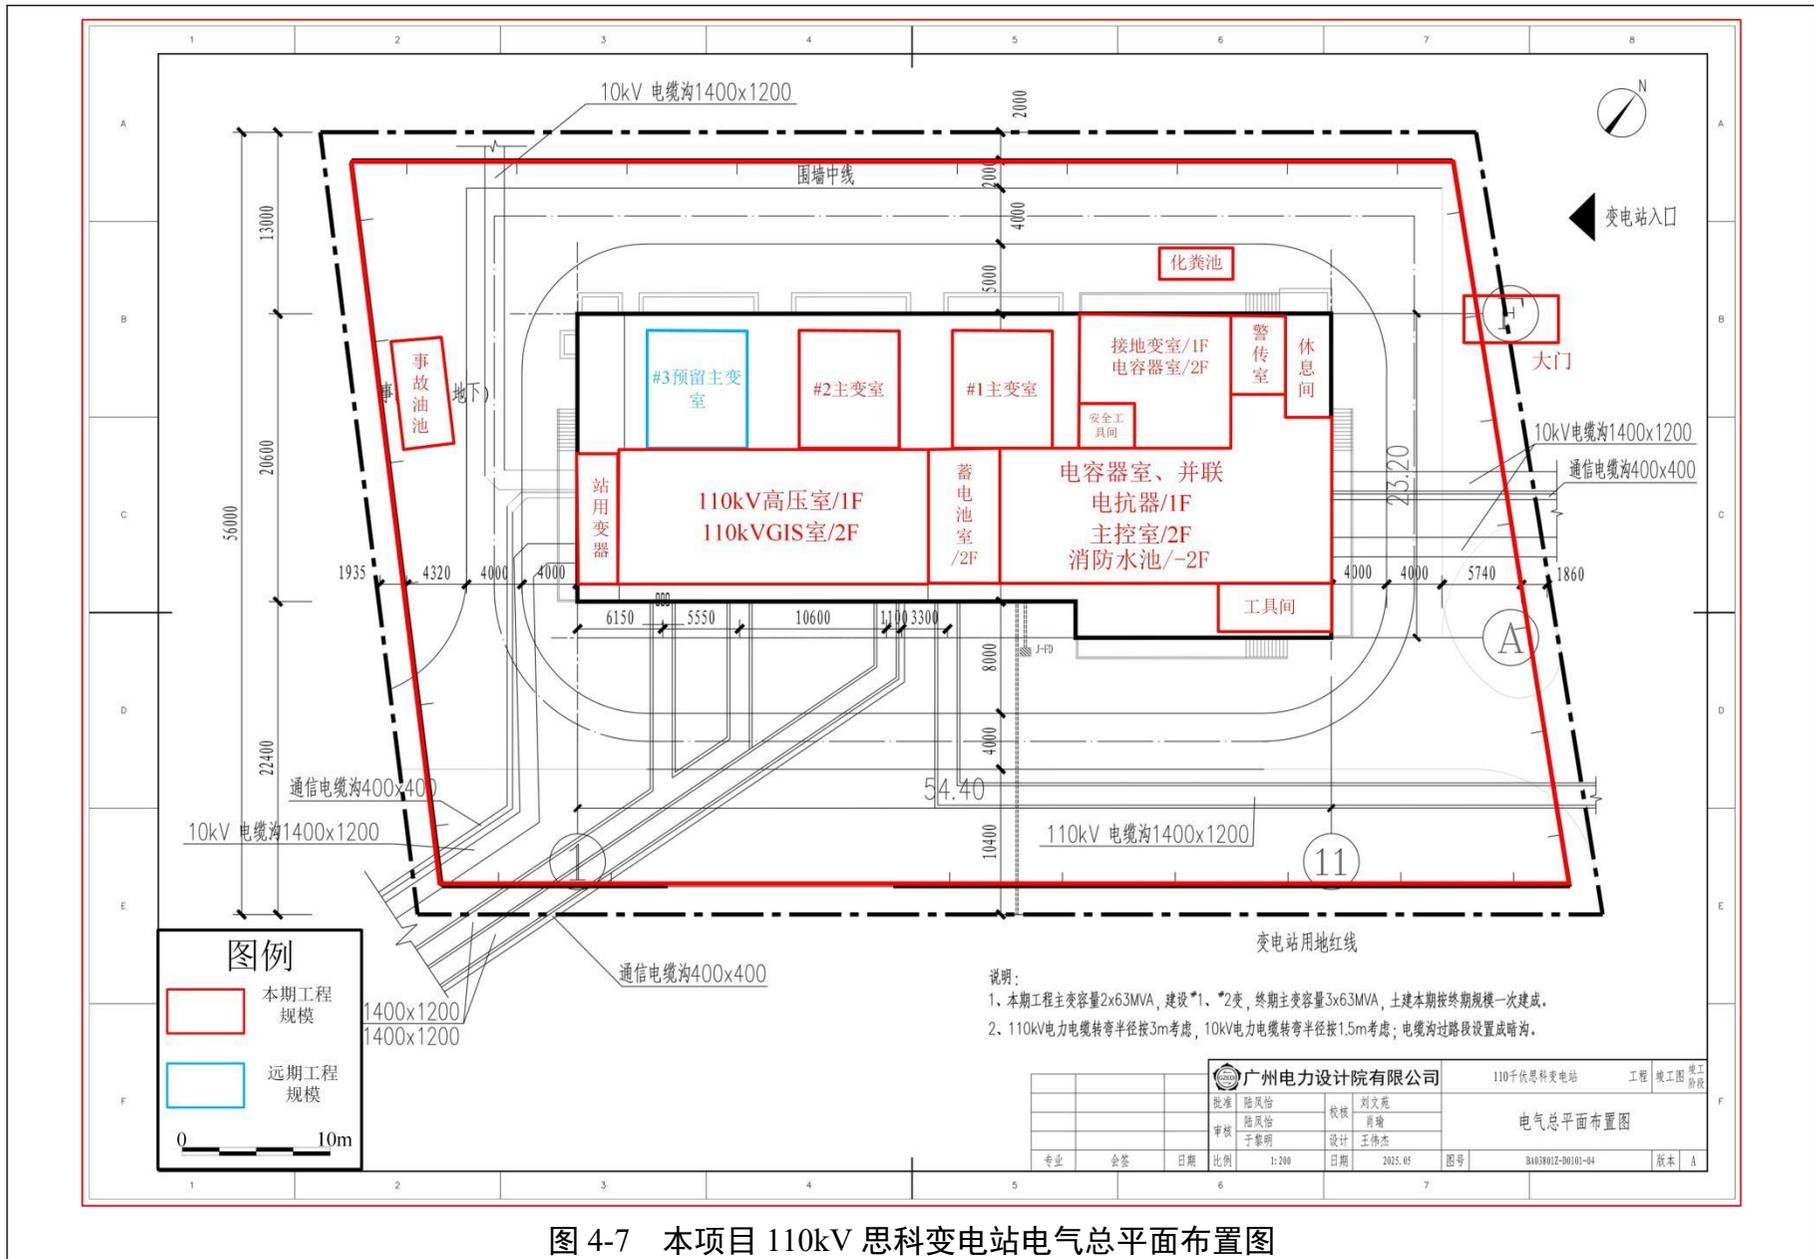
本项目 110kV 思科变电站电气总平面布置图
